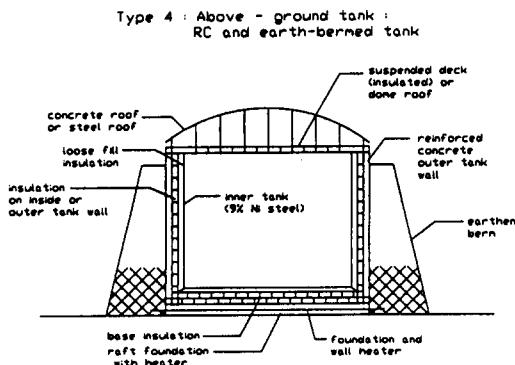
피트식－RC(Reinforce Concrete) 보강둑 탱크
